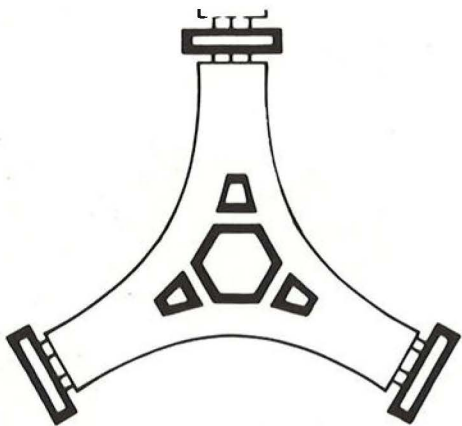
Stahlbetonhohlkörper der Stiegenhaustürme und des Zentralkerns im Grundriß eines Y-förmigen Gebäudes
